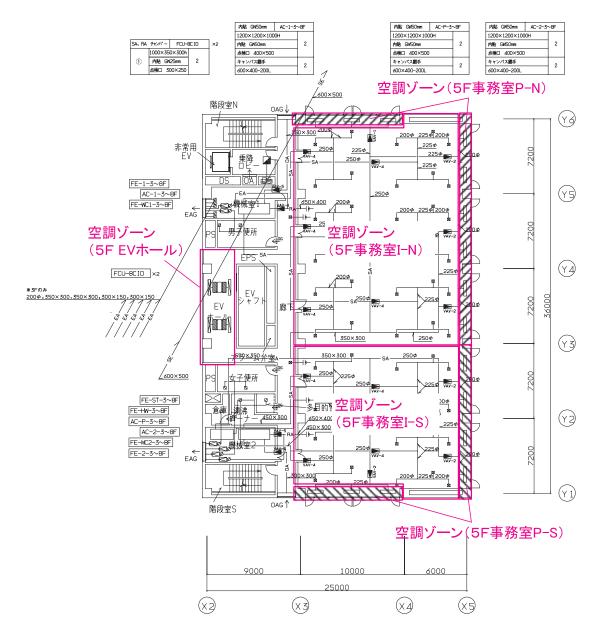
空調設備 3~8 階ダクト平面図 (図面 - 空 - 13)
